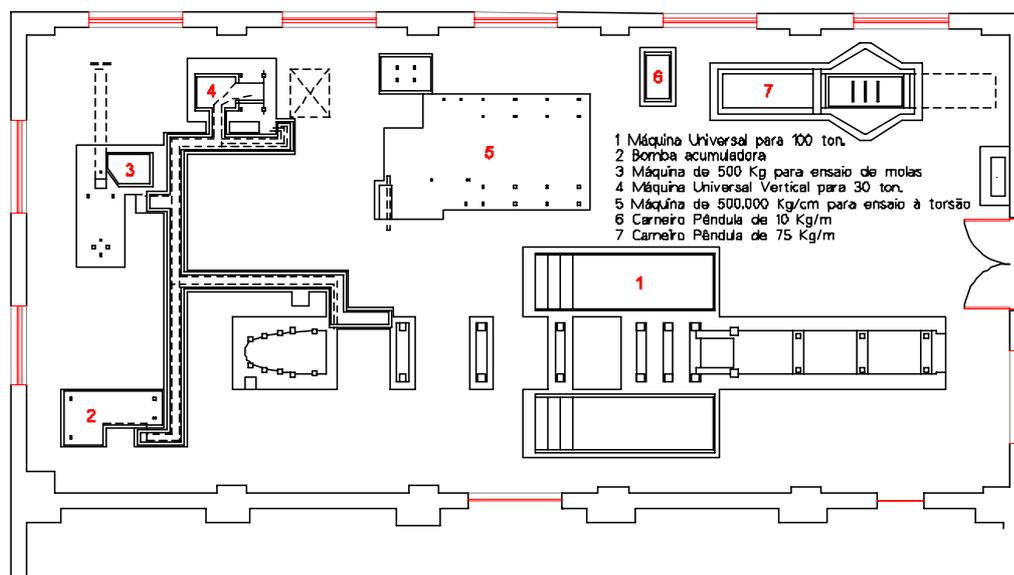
Planta Baixa do LRM publicada na EGATEA - 1914.
